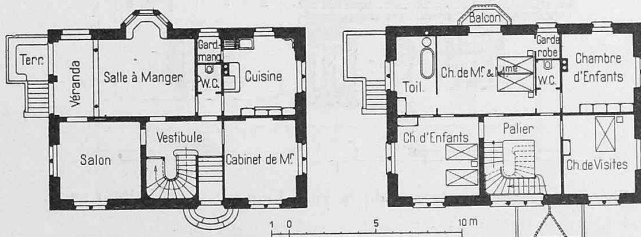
et 15. Plans du rez-de-chaussée et du premier étage de la villa Jäger à Lausanne. — Echelle 1 : 400.
